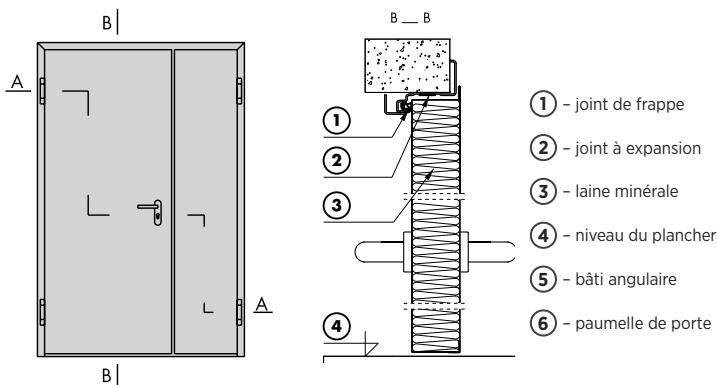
Blocs-portes coupe-feu en tôle d'acier de grandes dimensions à deux battants
